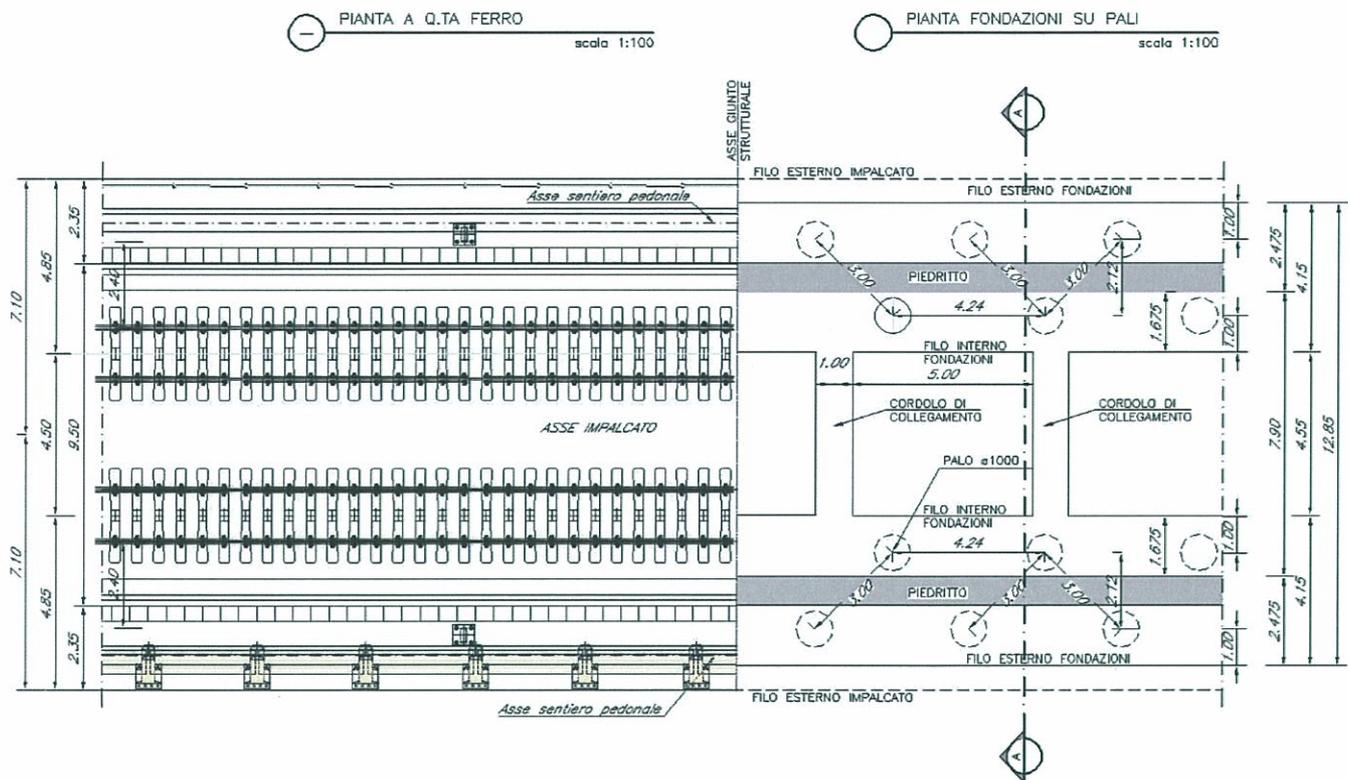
Pianta a quota ferro e pianta fondazioni dello scatolare.
